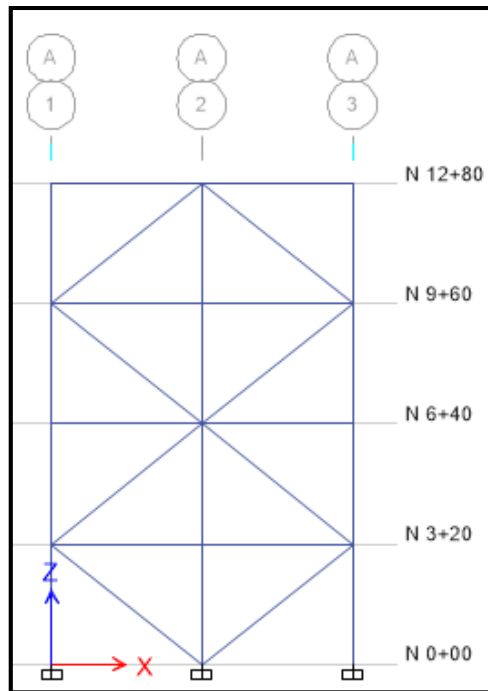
Elevación vista en el plano X-Z con pórticos arriostrados.
